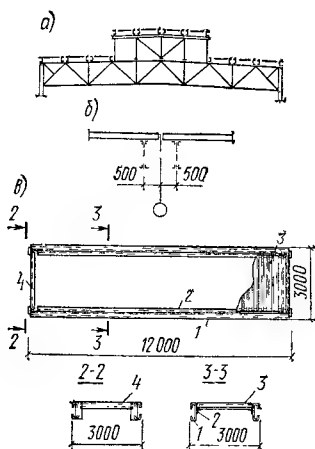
Металлические утепленные панели покрытий производственных зданий
